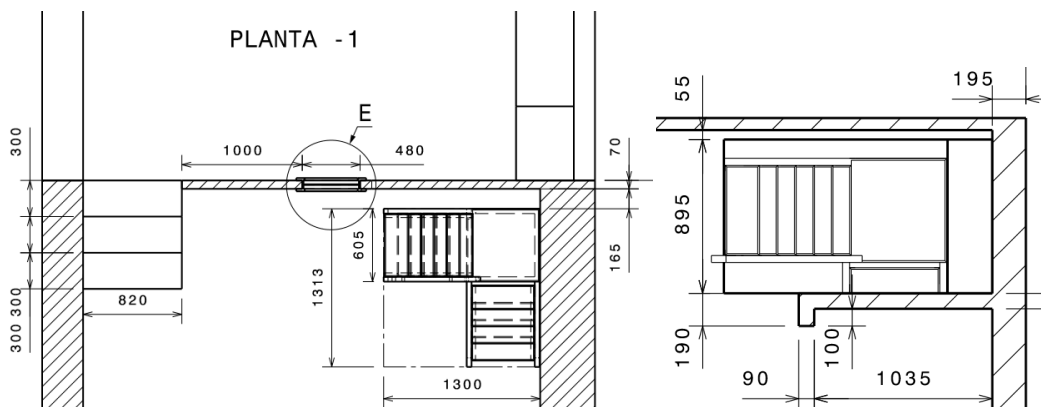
Detalle constructivo de tabiquería interna (izq.) y juego entre escalera y suelo de planta superior.
